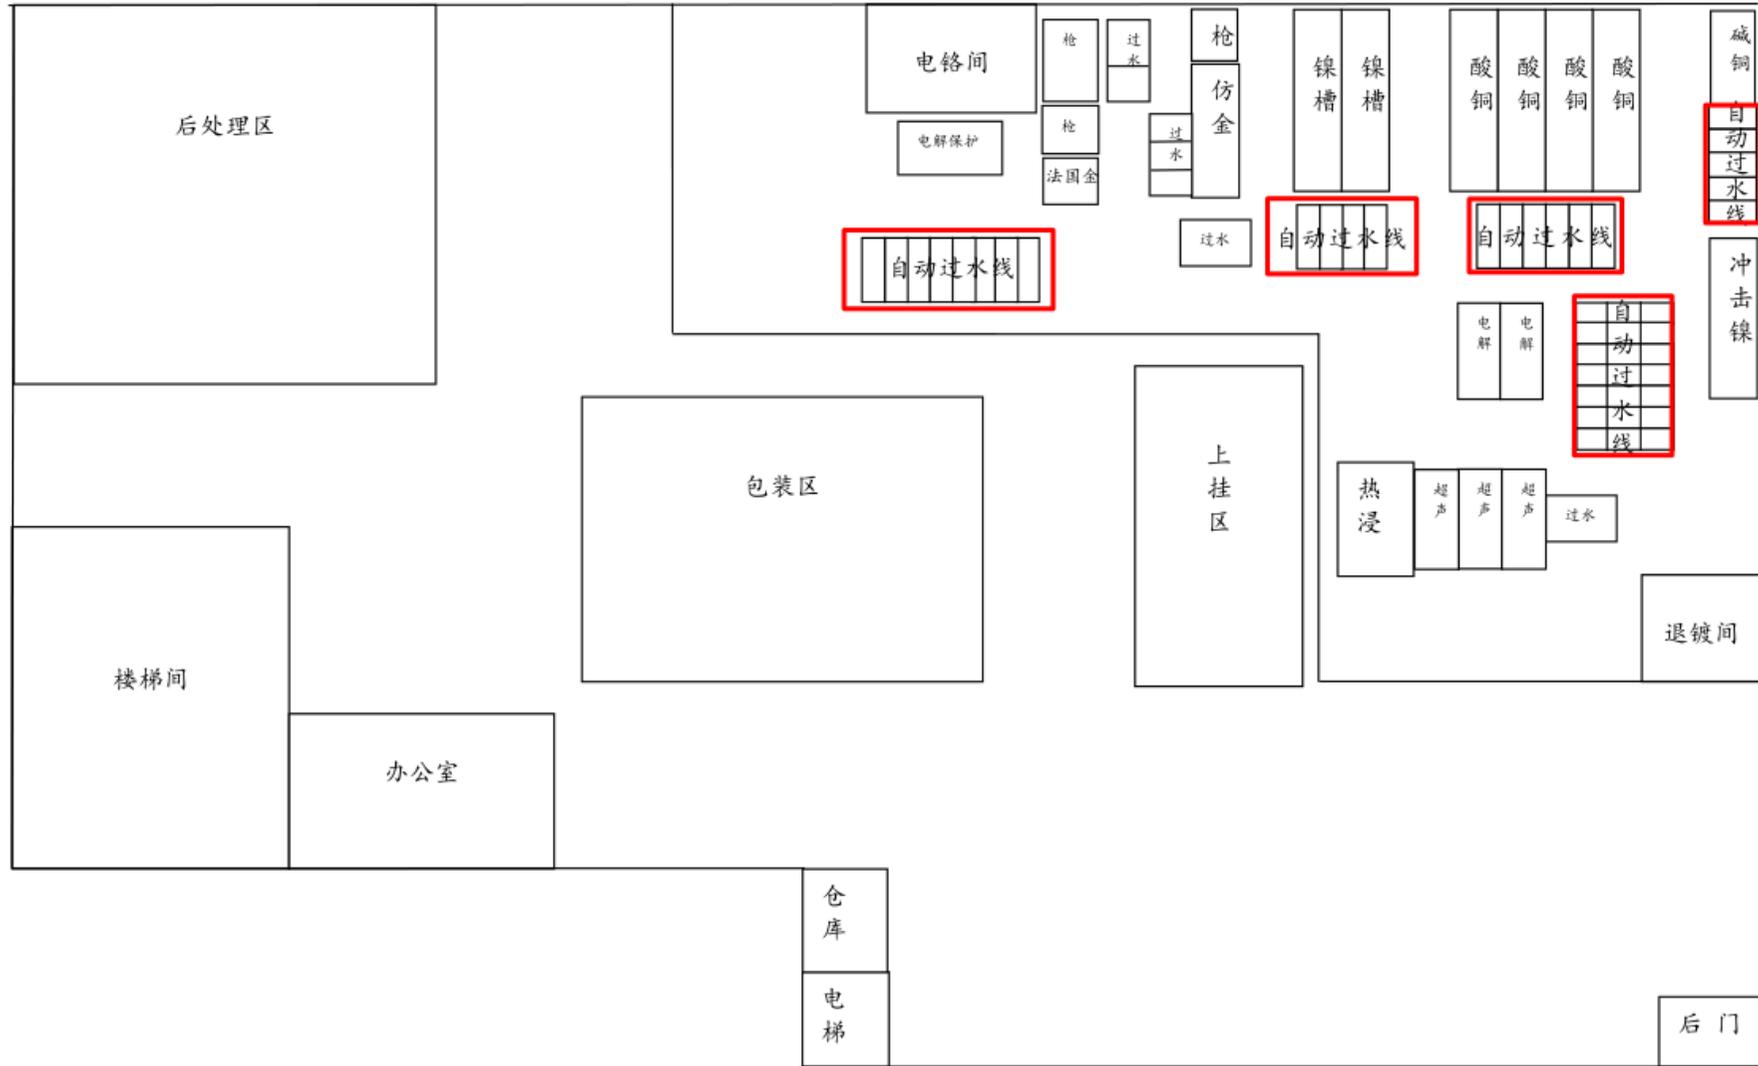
B 栋生产厂房 2 楼平面布置图
